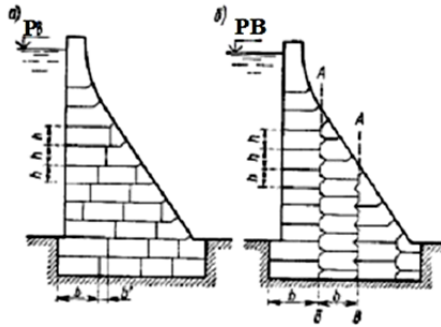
Розрізання бетонної греблі на будівельні блоки бетонування а – ярусна схема; б – стовпчаста схема
